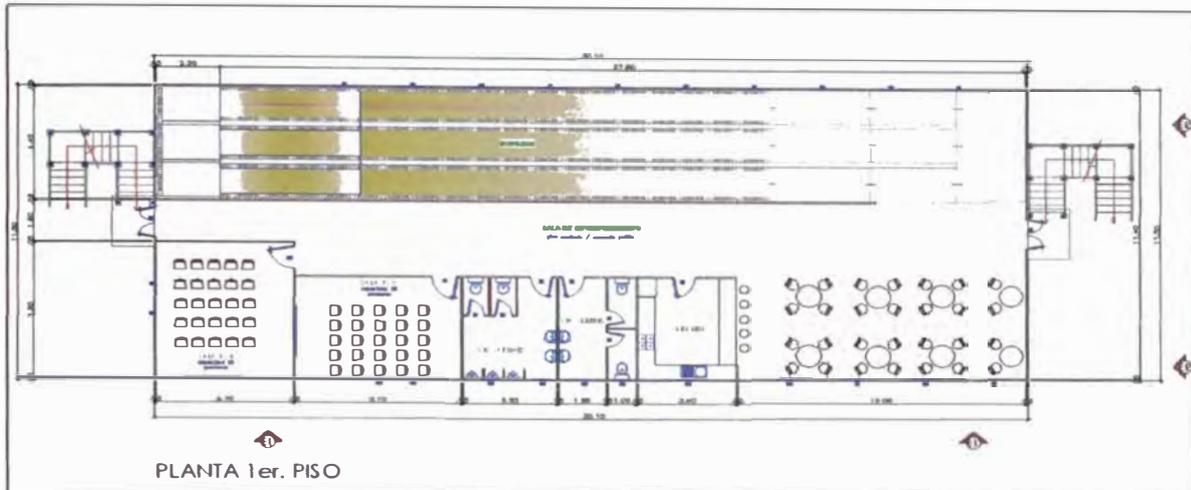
Modulo fijo para uso recreación 1er nivel (proyecto campamento ZANJA Buenaventura – en ejecución).
